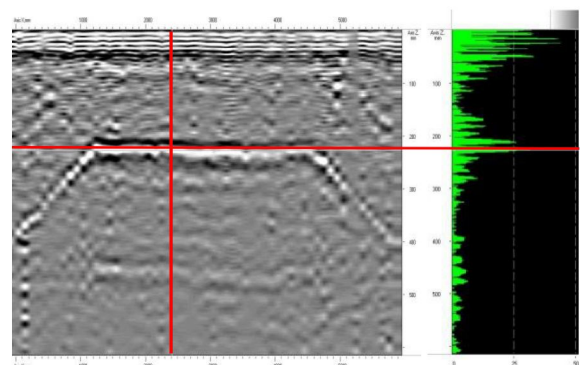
Linienmessung mit Rückwandecho, Bauteildicke 23 cm, an Einzelmessungen ablesbar
